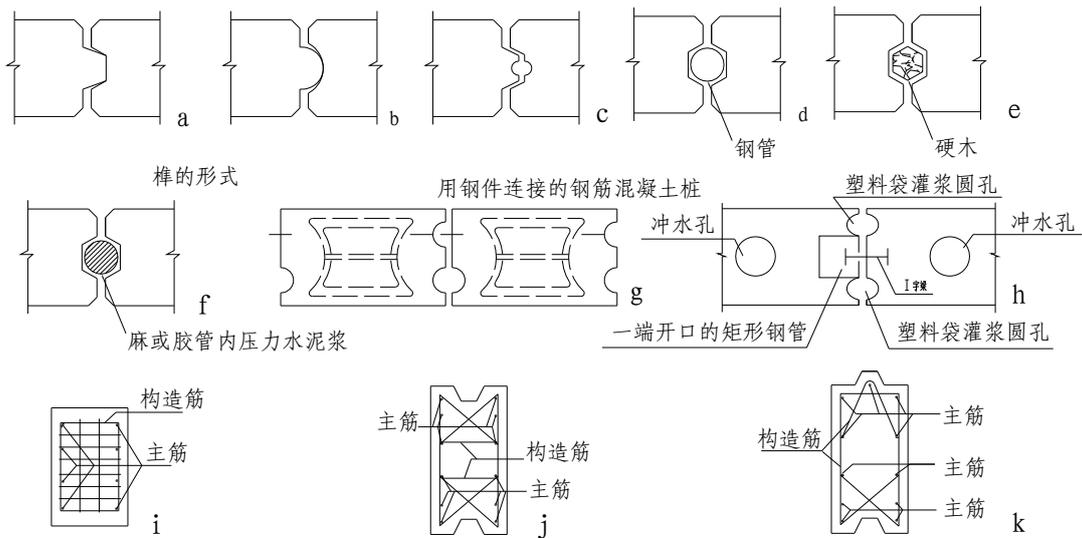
钢筋混凝土板桩的榫槽及配筋布置图
